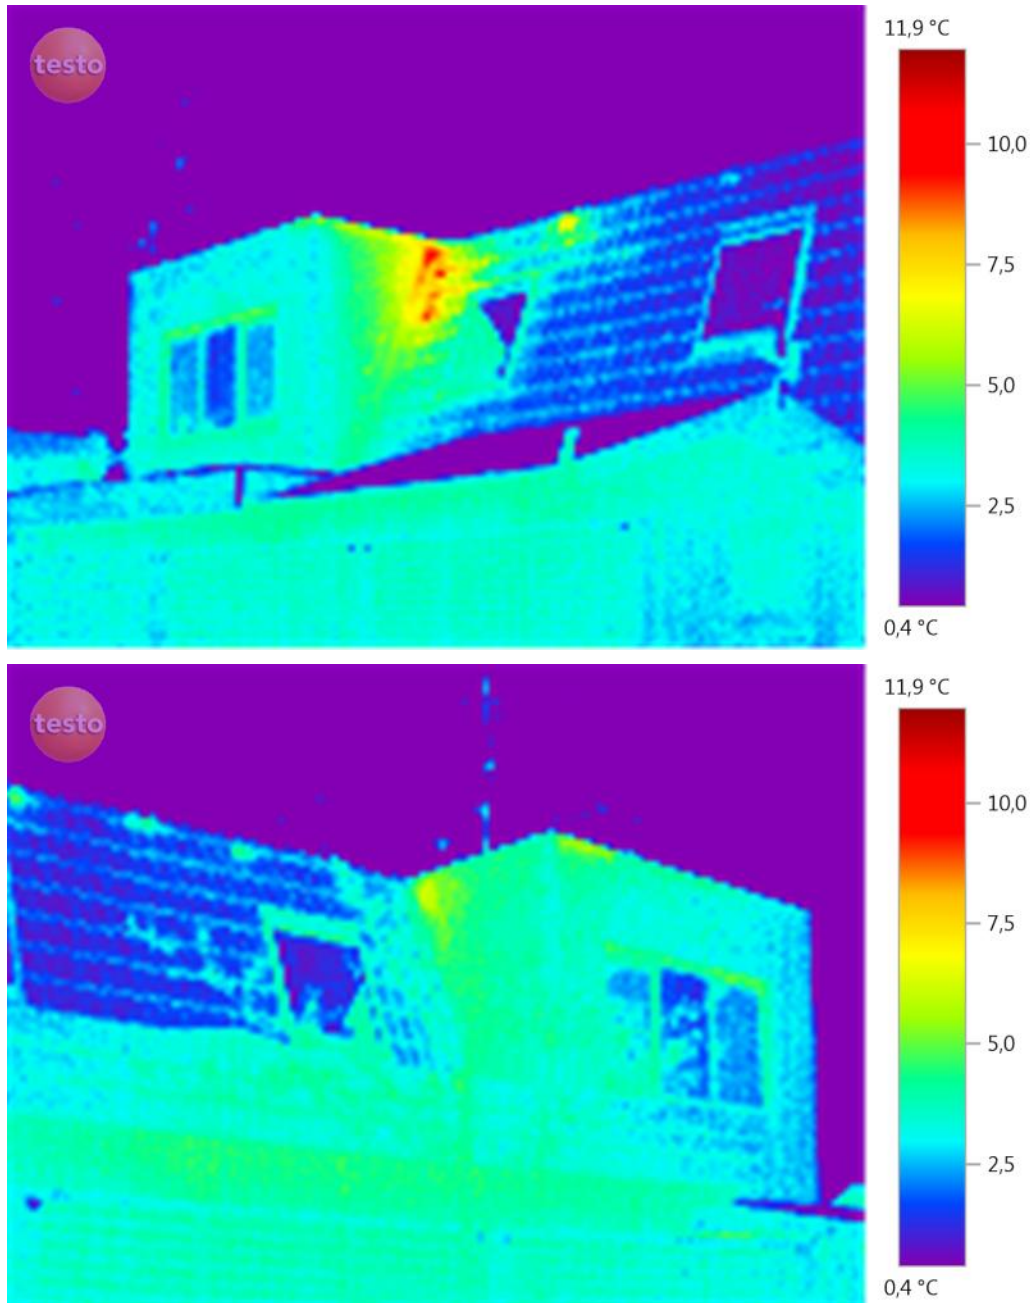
Ventilatievoorzieningen dakraam staat open evenals de ventilatieroosters in het dakbeschoot tussen de dakramen.
